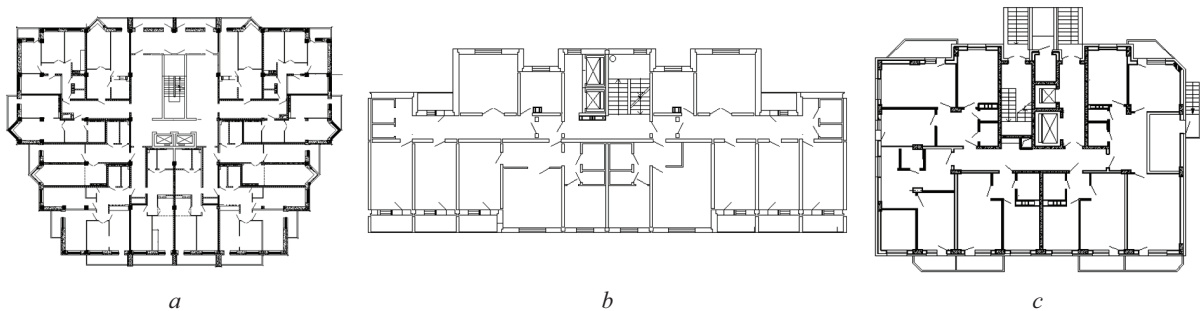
Планы зданий: а — здание 1; б — здание 2; в — здание 3
